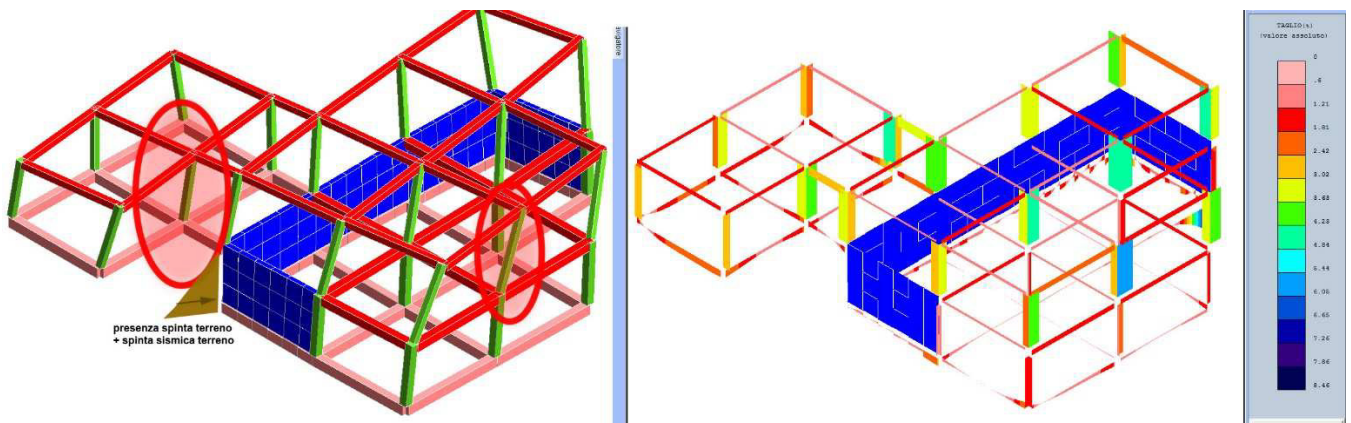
Struttura con travi di fondazione su due livelli e collasso a taglio dei primi elementi strutturali.
